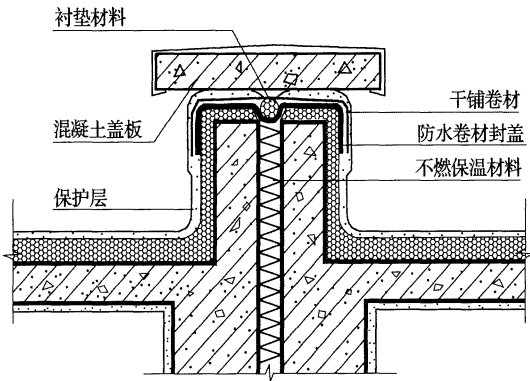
喷涂硬泡聚氨酯屋面变形缝防水构造
